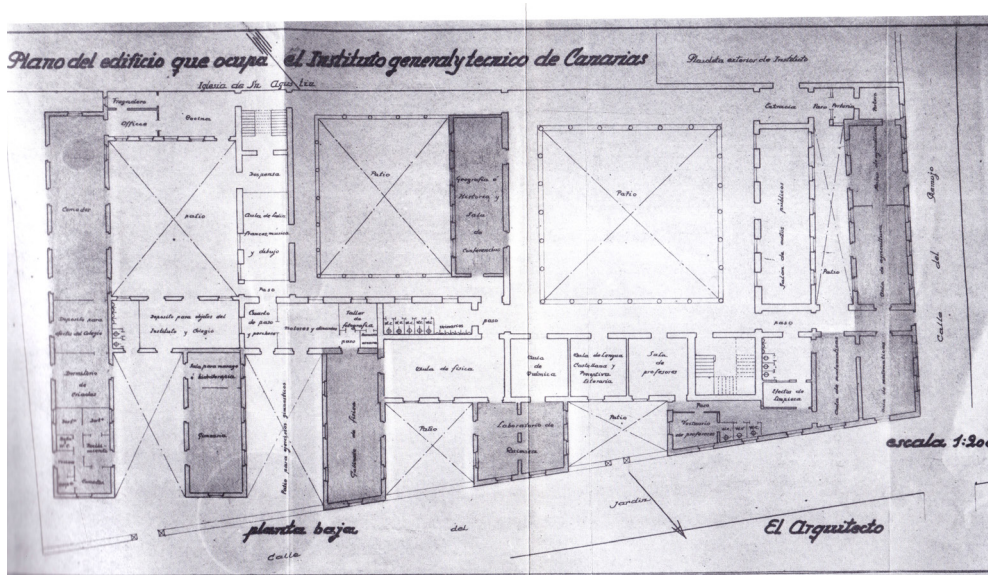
Plano de estado reformado de 1915 (Autor: Pelayo López, 1915)
